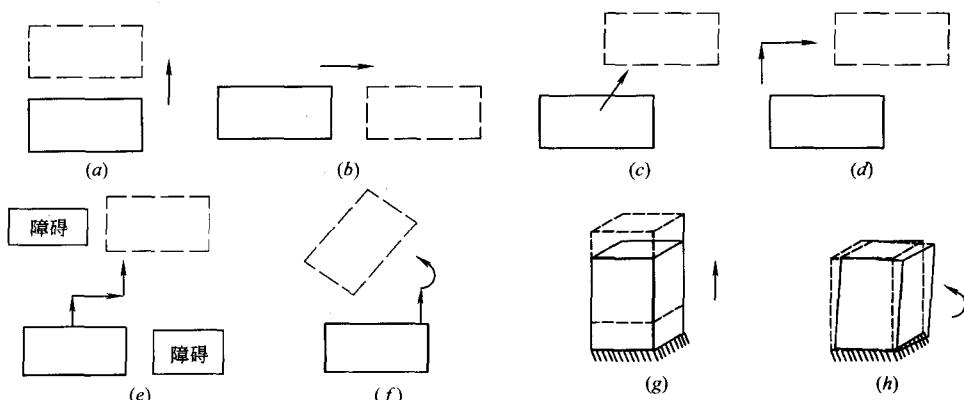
建筑物整体迁移示意（注：其中 a~f 为移动位置平面图）
